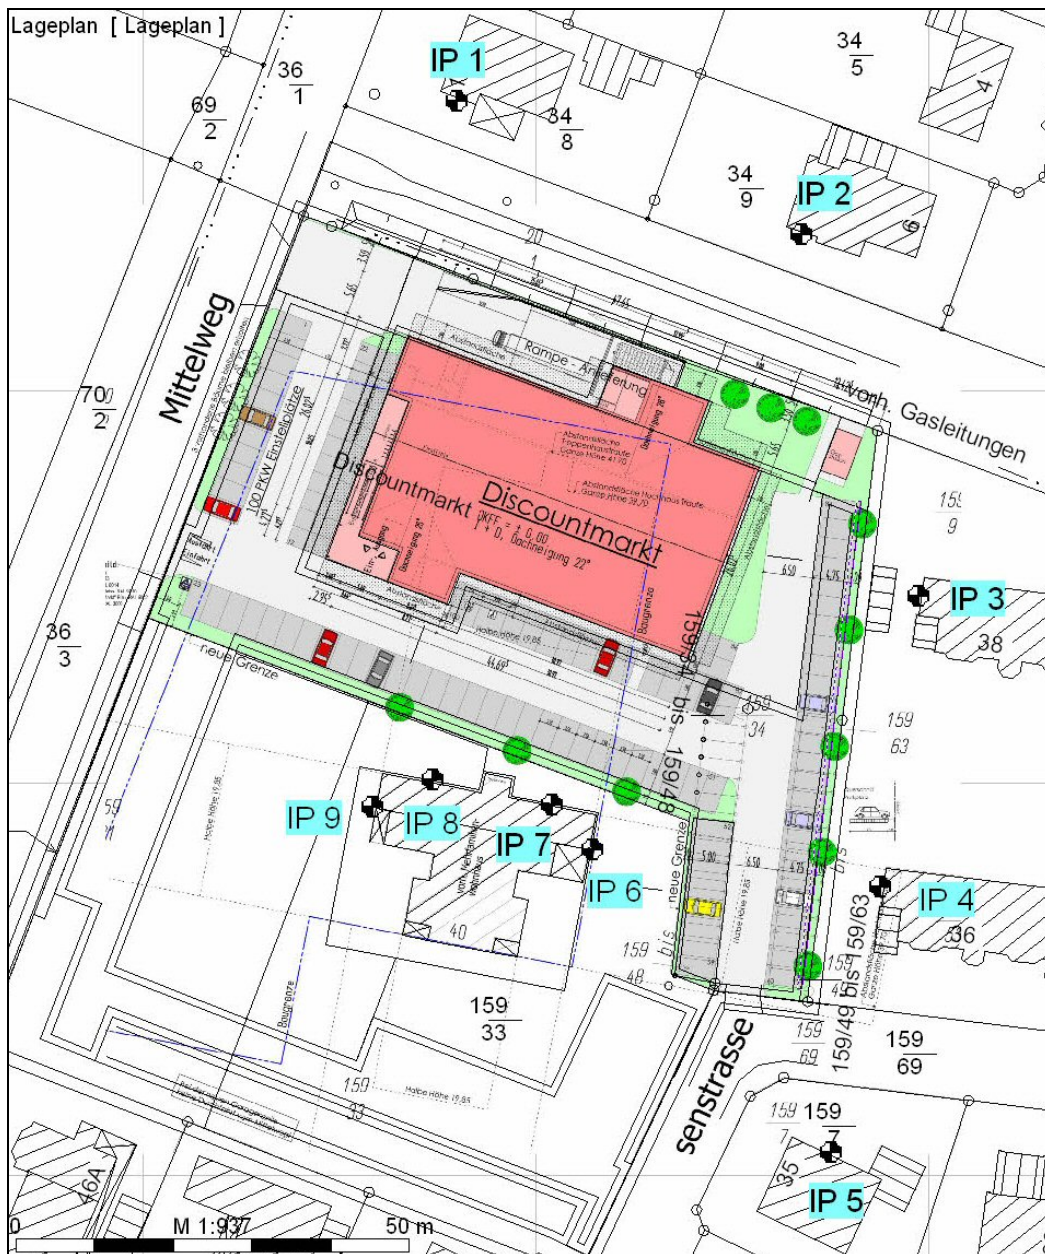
Übersicht über das künftige Betriebsgelände und Lage der Immissionspunkte.
